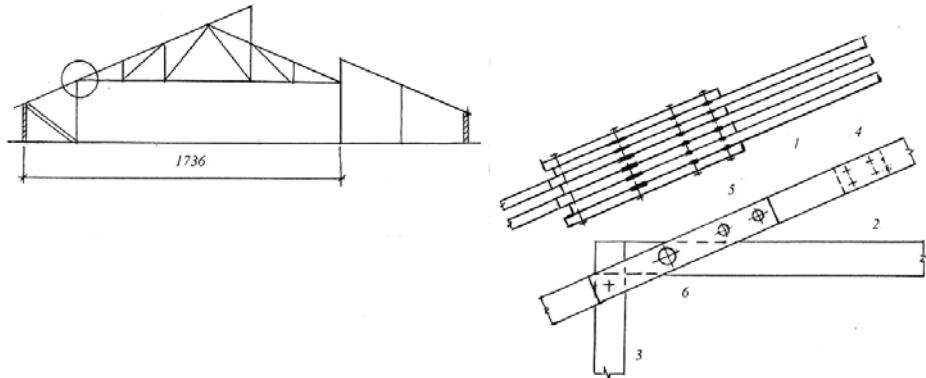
Покриття з фермами з дощок (1970 р.)
